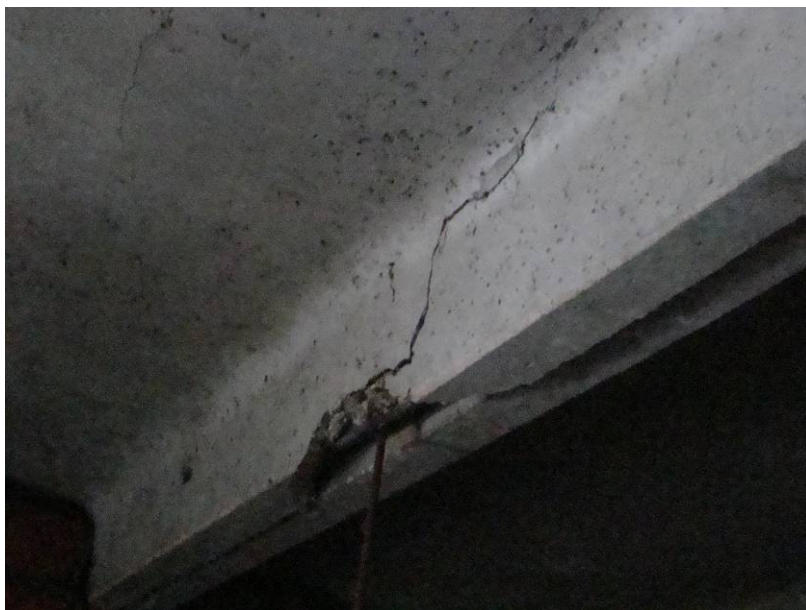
Разрушение бетона ребра плиты покрытия с оголением арматуры и креплением к ней на сварке кронштейнов трубопроводов. Требуется усиление.
